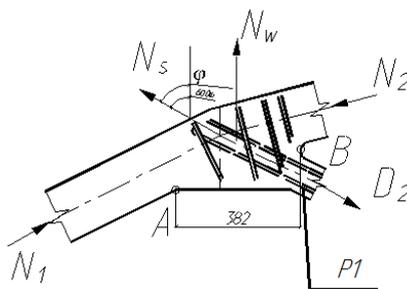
Схема к расчету узла 2 верхнего пояса
